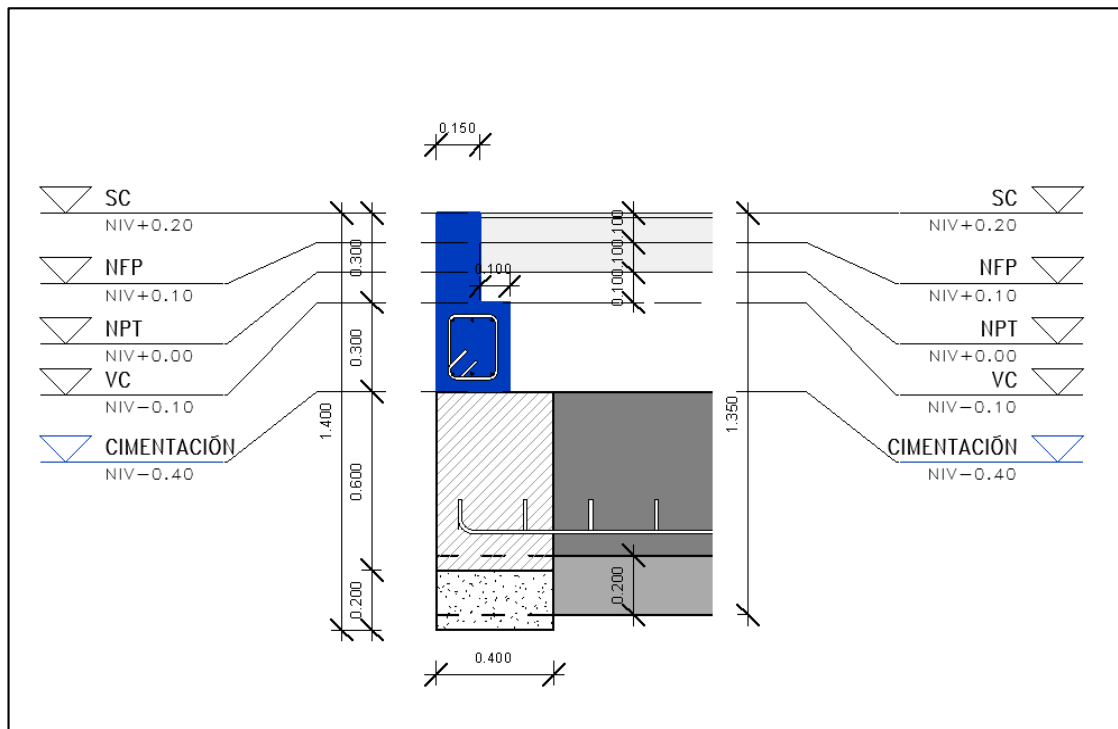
Sección Sobrecimiento Reforzado en BIM
